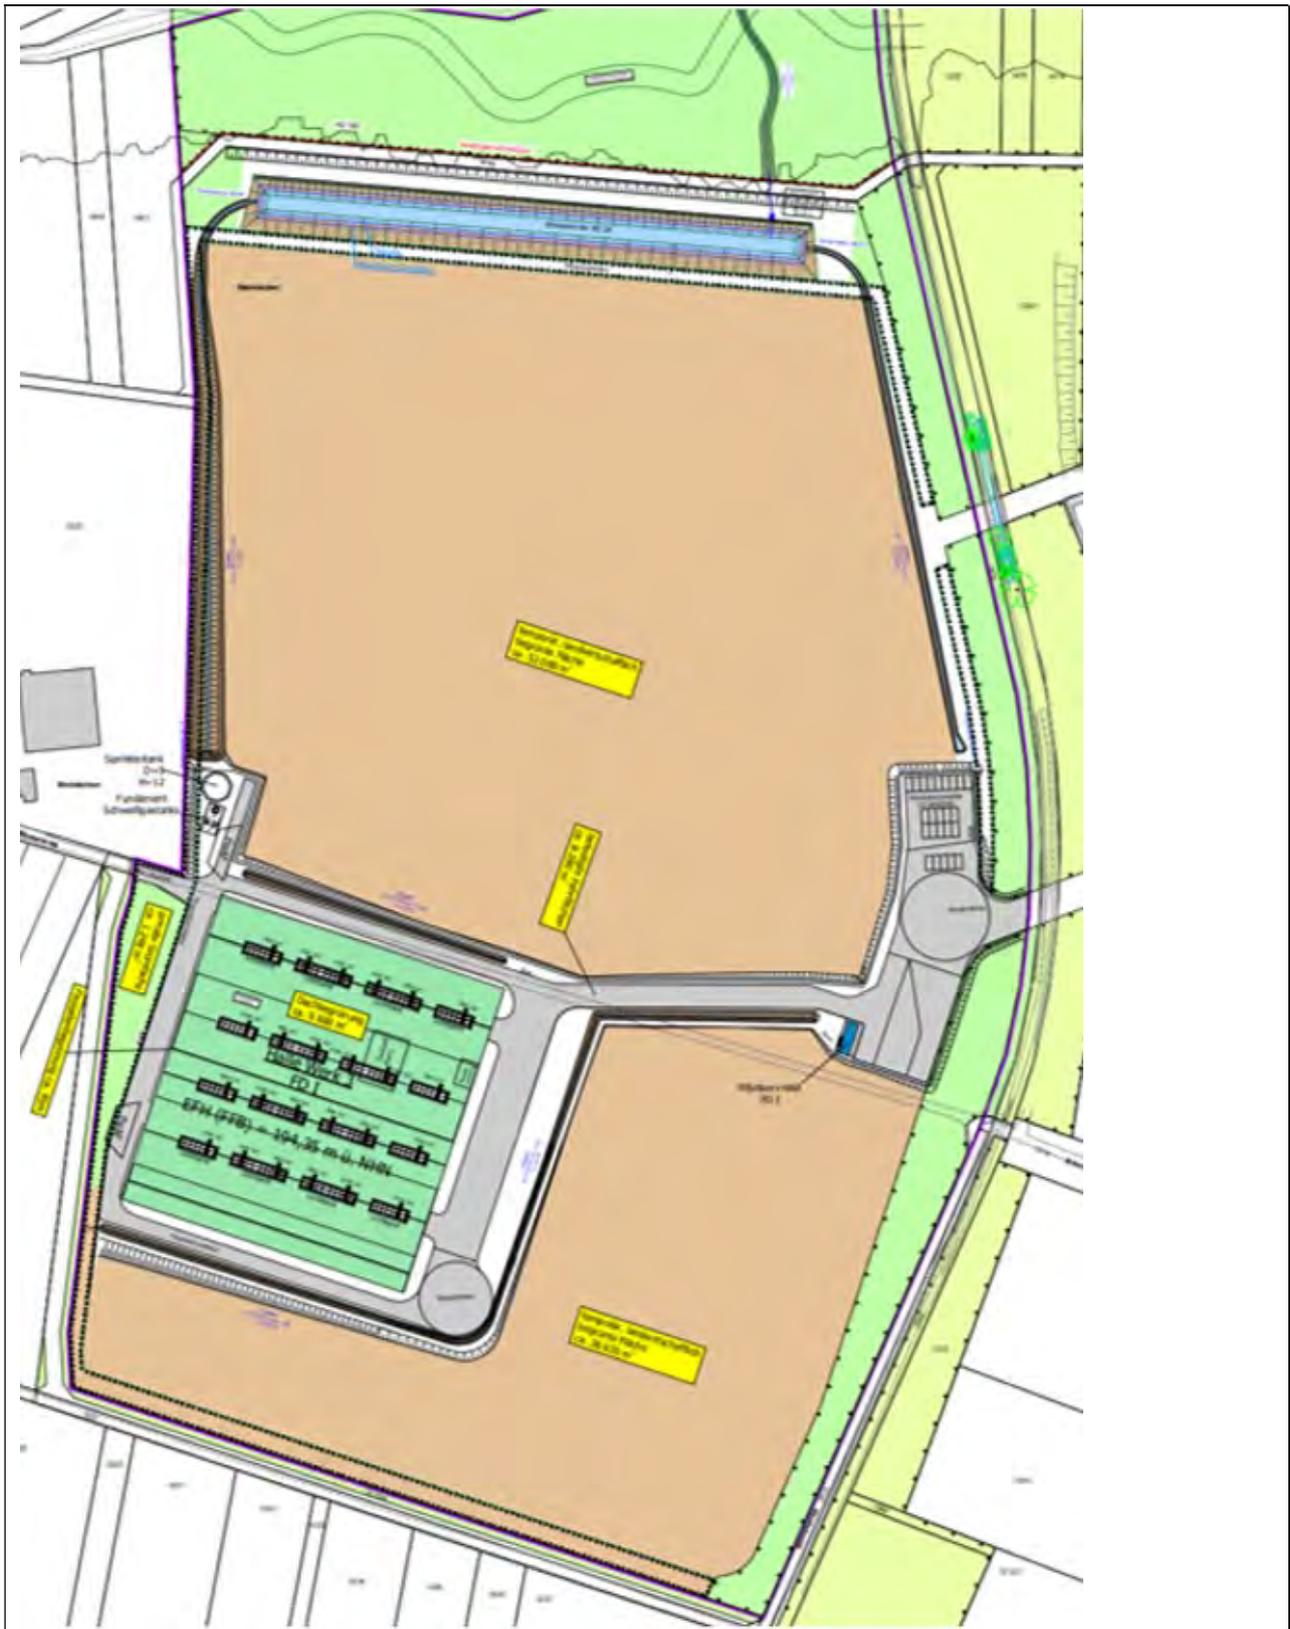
Flächenangaben des BA1 – liegt als Plan dem UB bei
